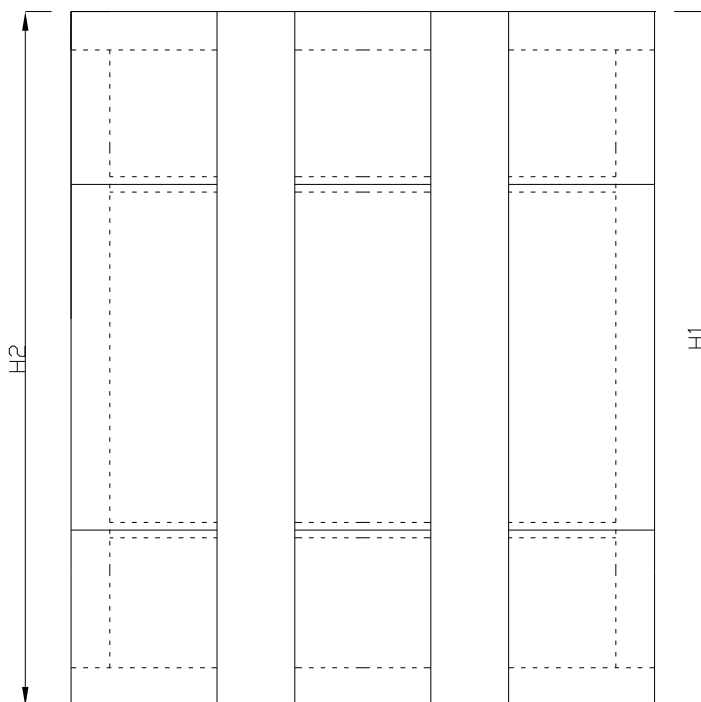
Ustalenie podpór oraz profilu giętego zgrzewanego z kątownikiem względem otworu w murze.
